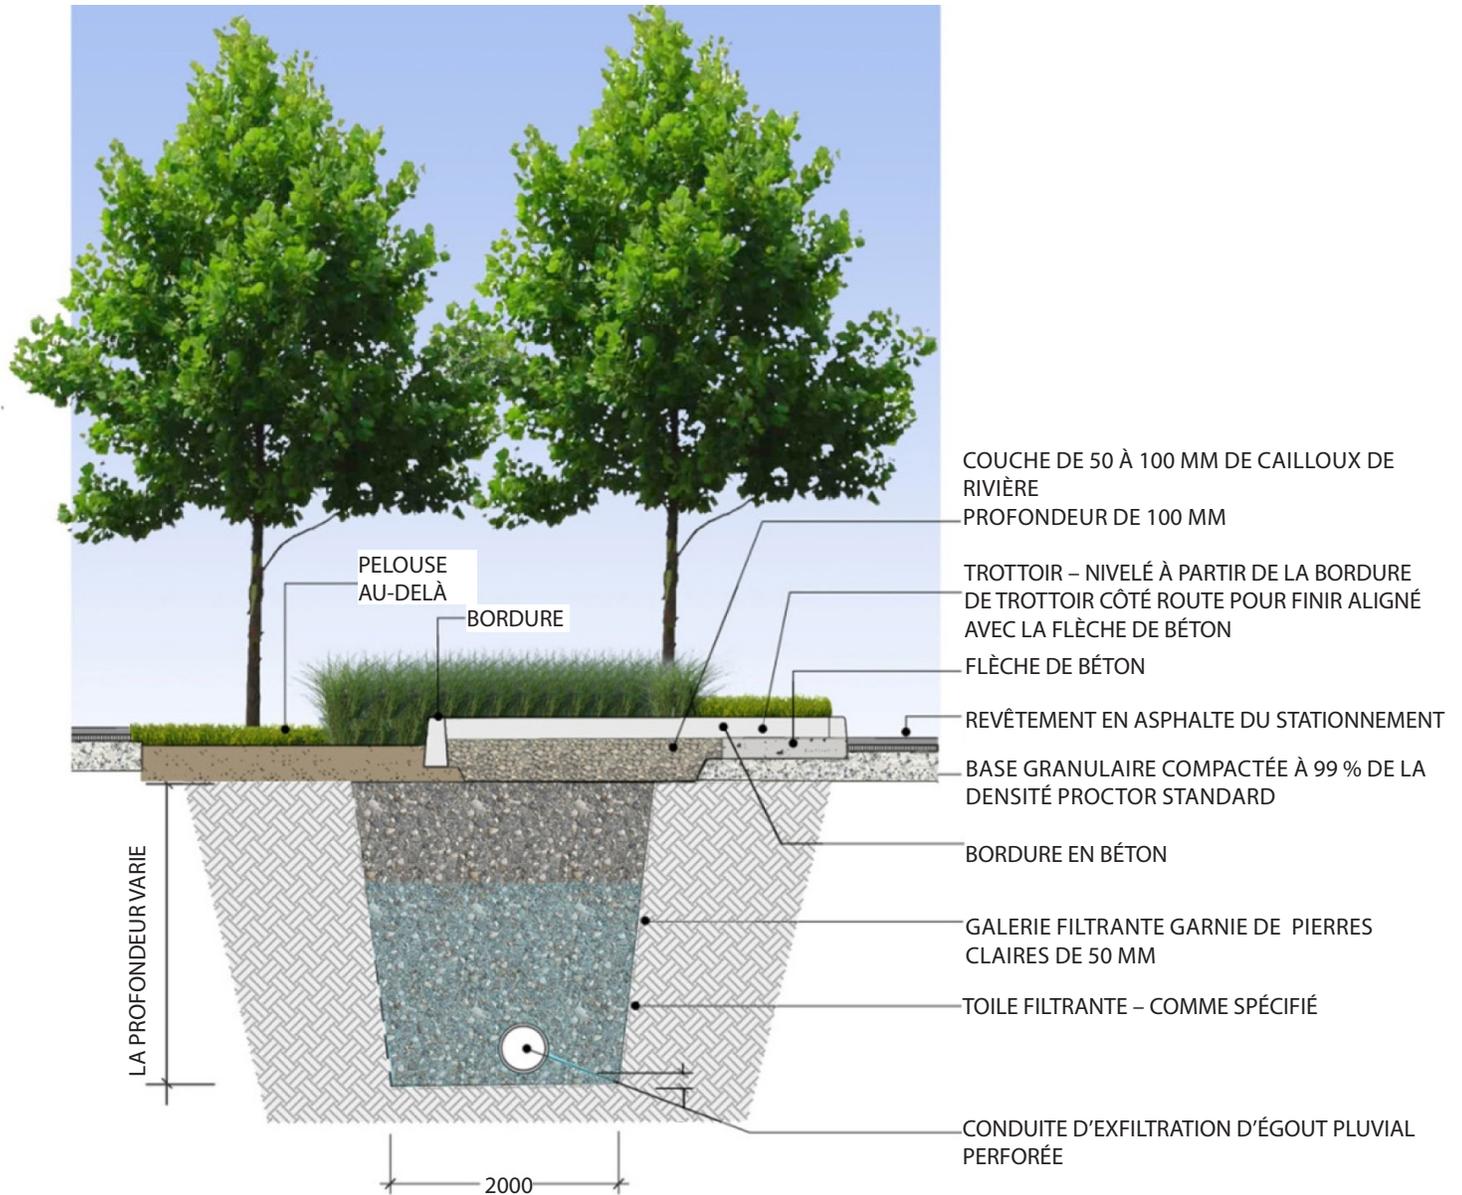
Coupe transversale d'un biofiltre (avec la permission de Schollen and Company Inc.)
